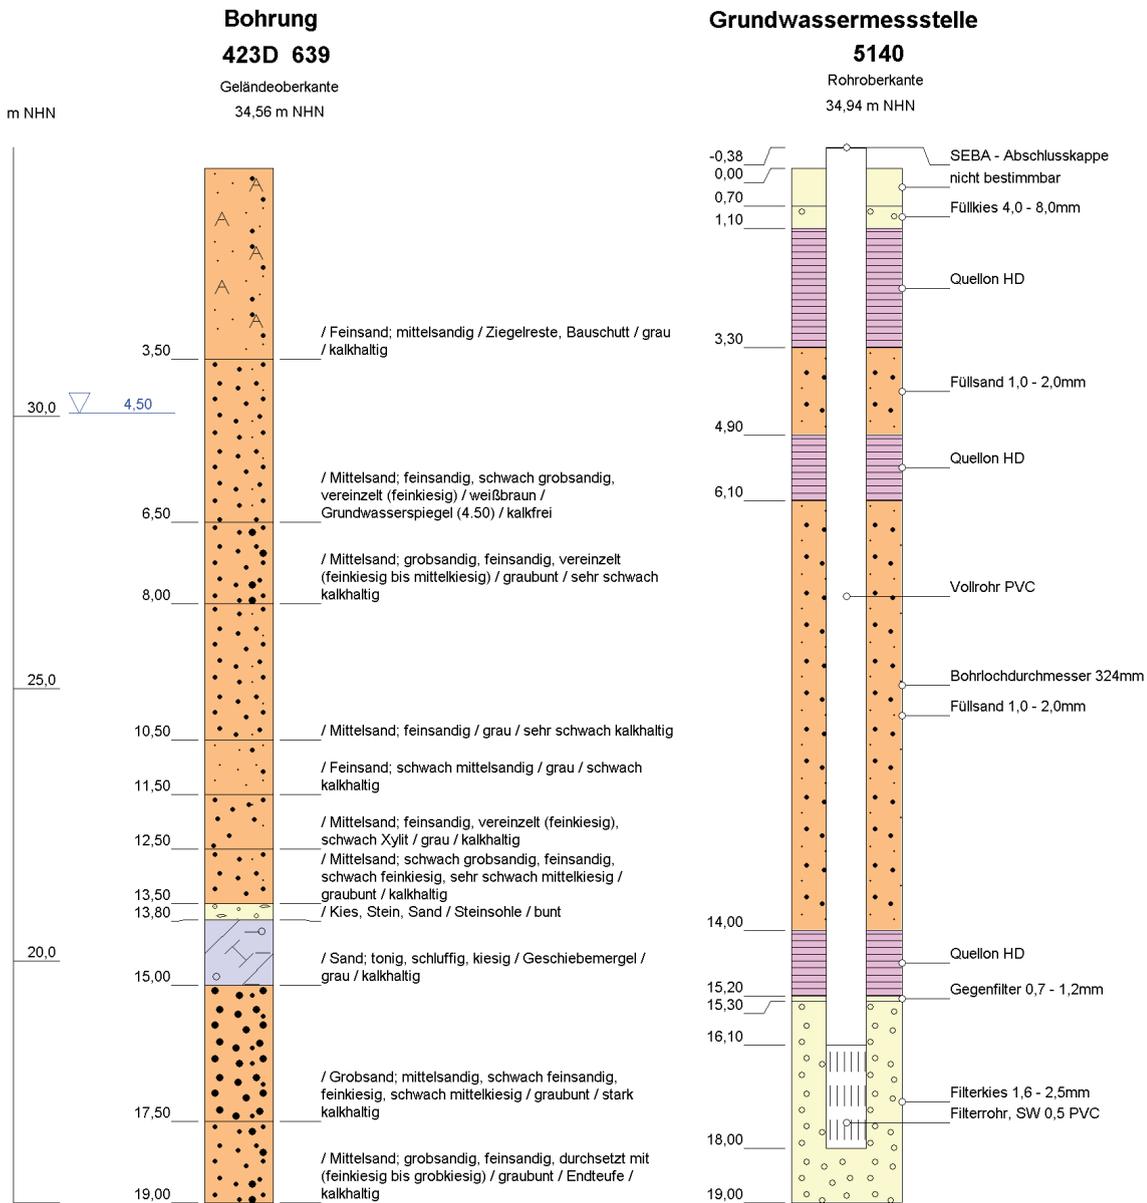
Ausbau einer Grundwassermessstelle
